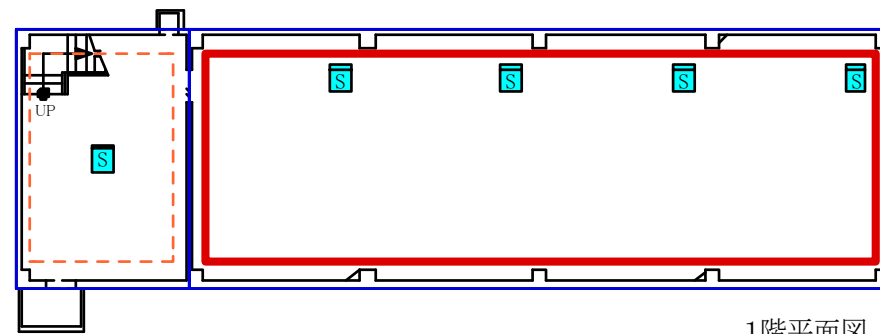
2 1 β・γ一時格納庫 I 平面図及び可燃物配置図
